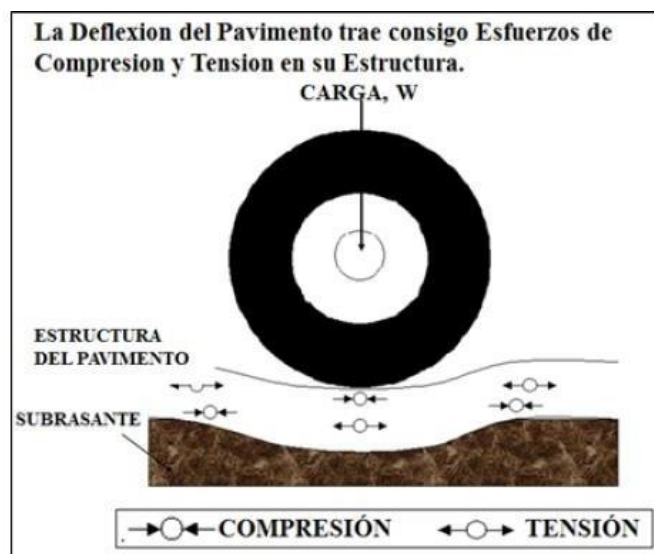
“La Deflexión del Pavimento” Fuente: Manual de Pavimentos, Néstor Huamán G.
